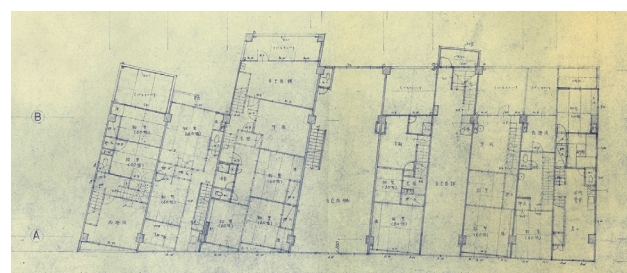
氷見/中央町「共同ビル5」の設計図書：2階平面図
